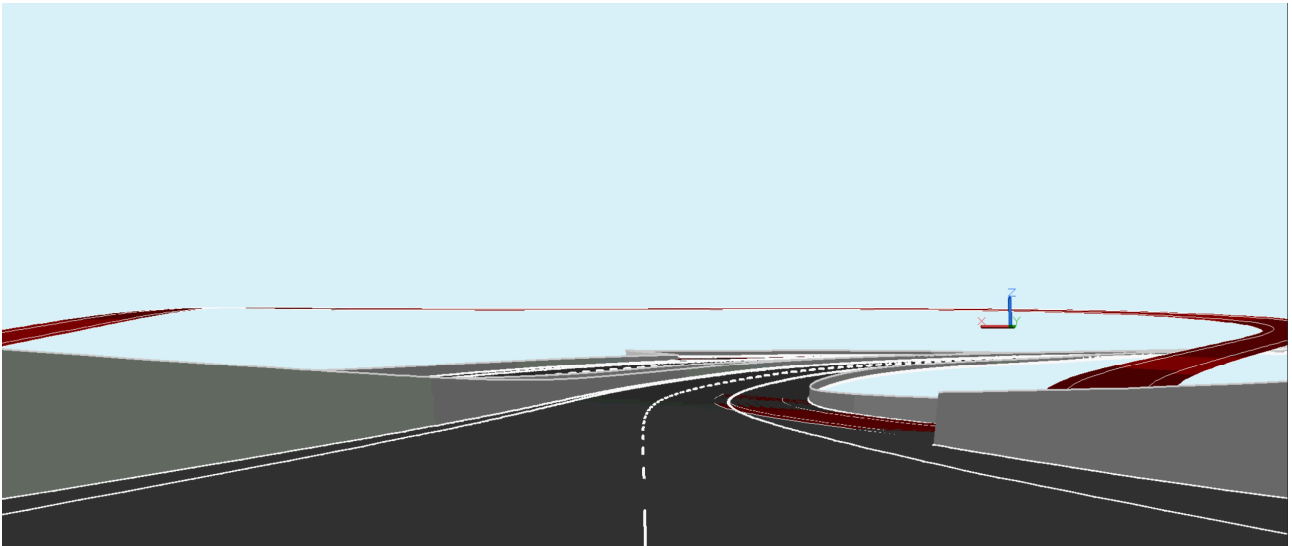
Visione prospettica in uscita curva planimetrica 6 (Carr. FA-GR)
